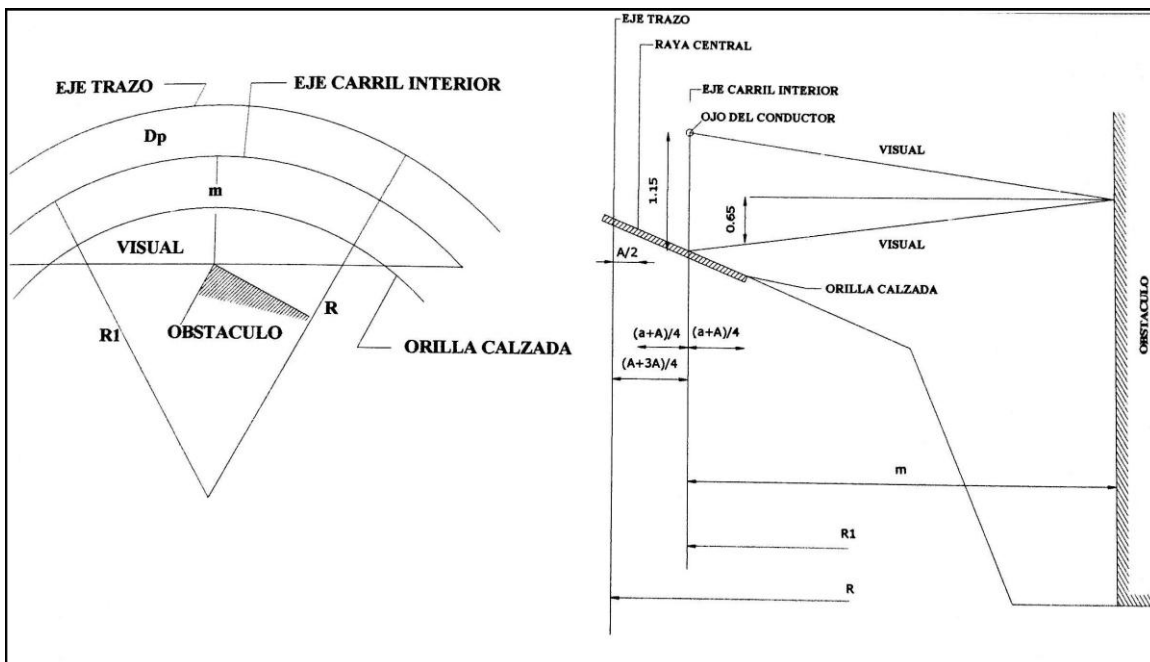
Distancia del eje del carril interior al obstáculo (m).
